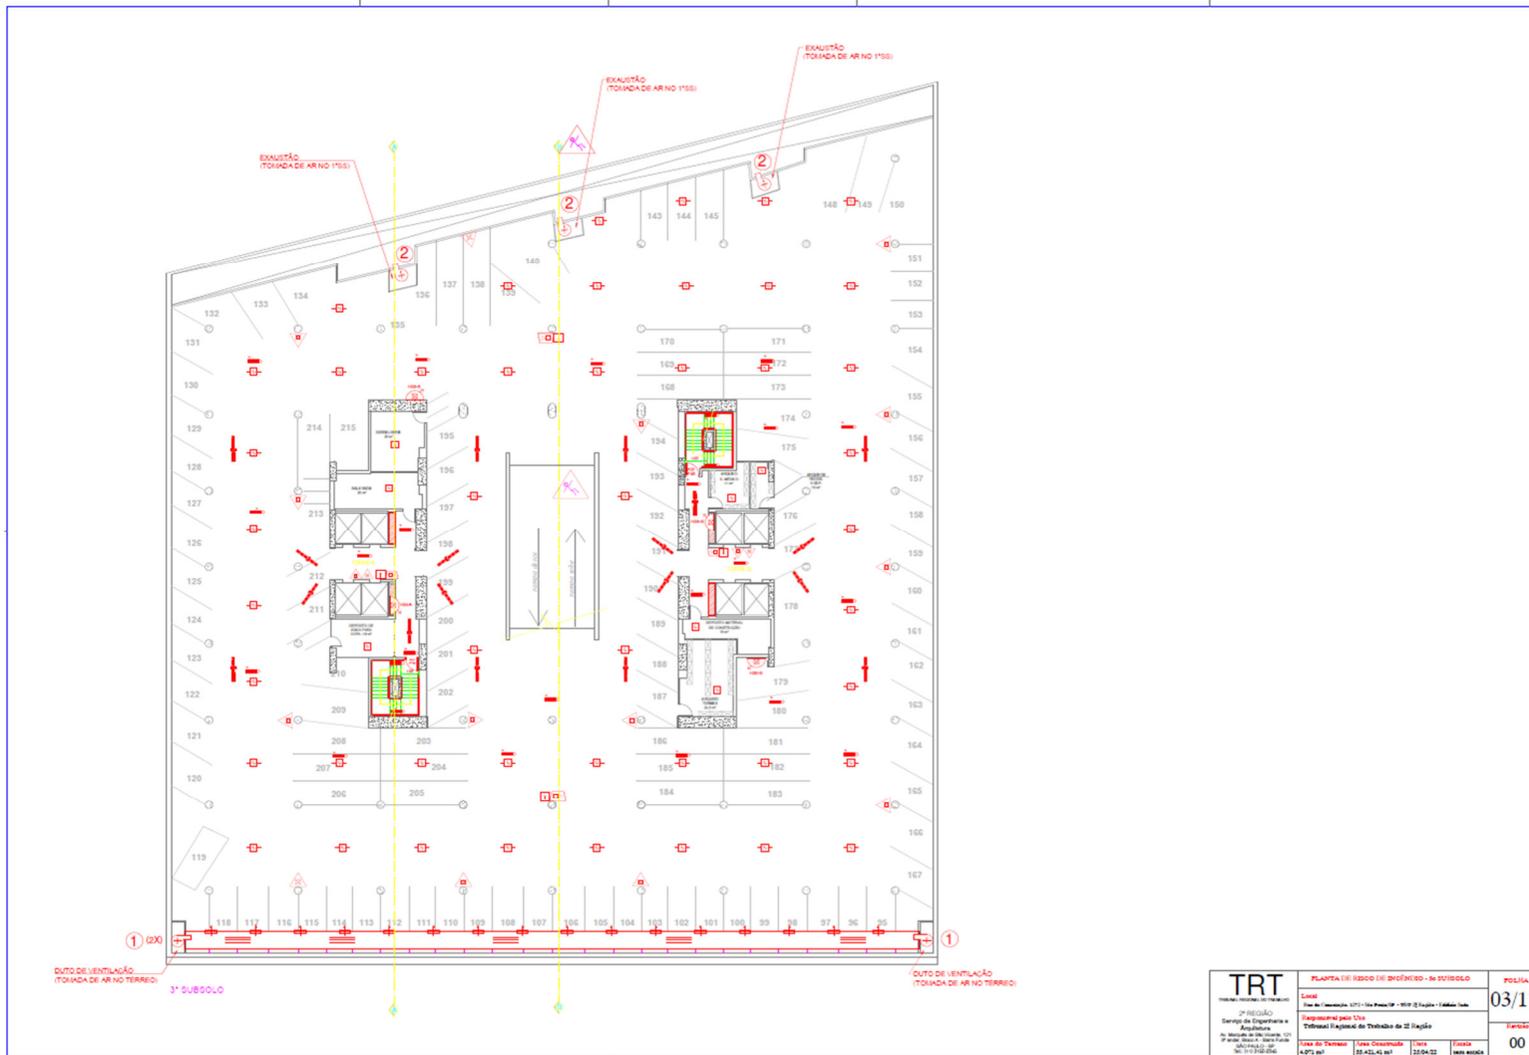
Planta de Risco de Incêndio - 3º Subsolo
